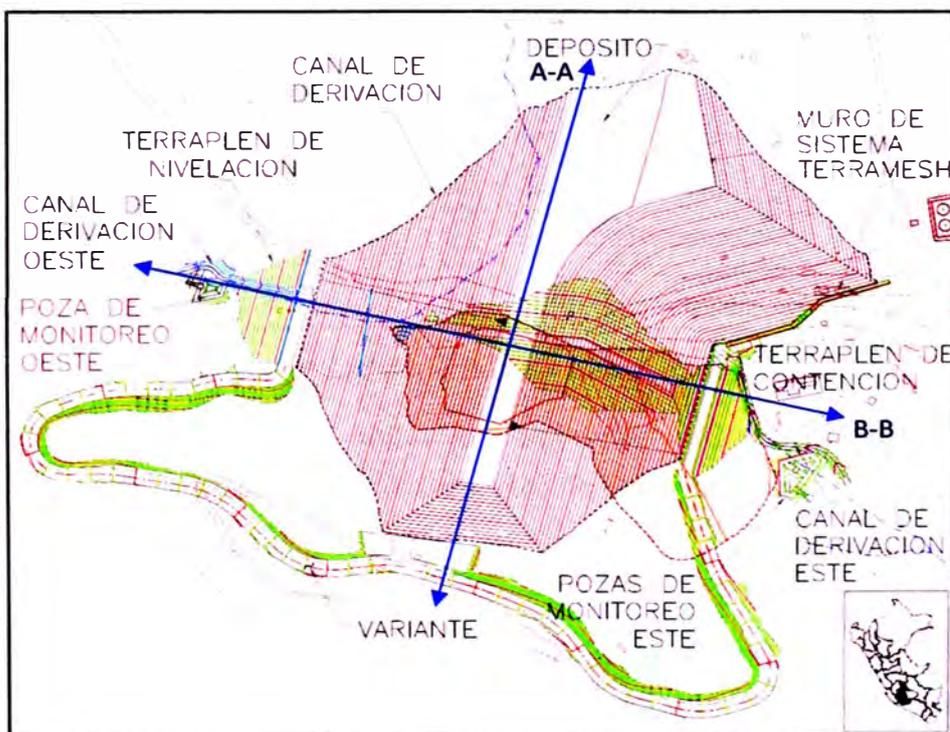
Esquema en Planta del Botadero de Desmonte
